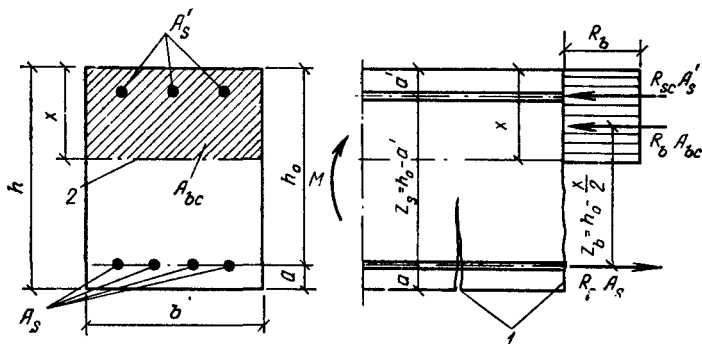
Прямоугольное сечение с двойной арматурой и схема усилий при расчете прочности элемента по нормальному сечению
